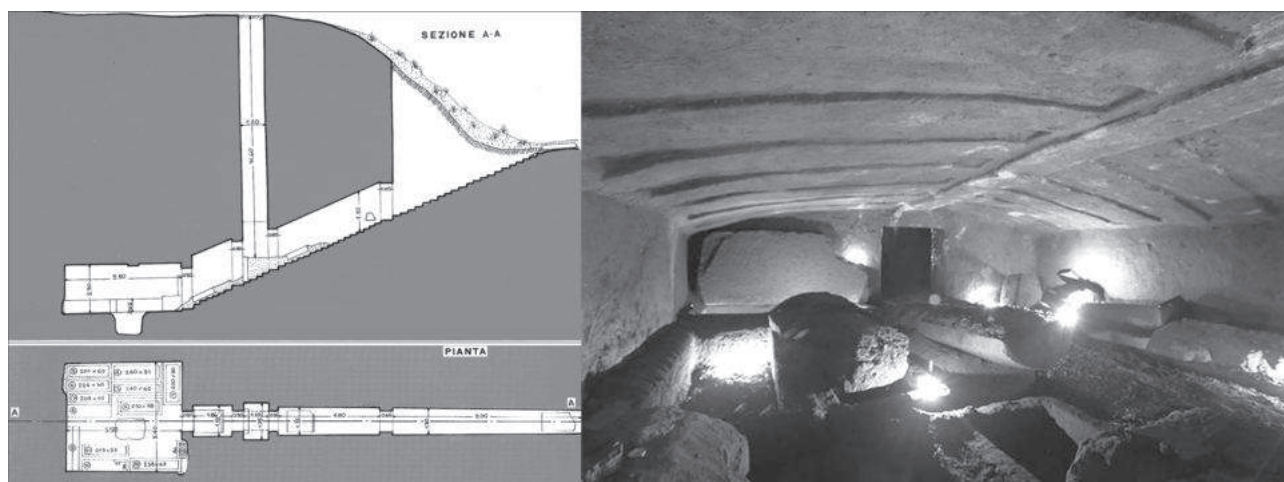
Necropoli di Poggio Giudio: pianta e sezione della Tomba 3 (rielab. da PROIETTI & SANNA 2013, fig. 289) e foto dell'interno.
